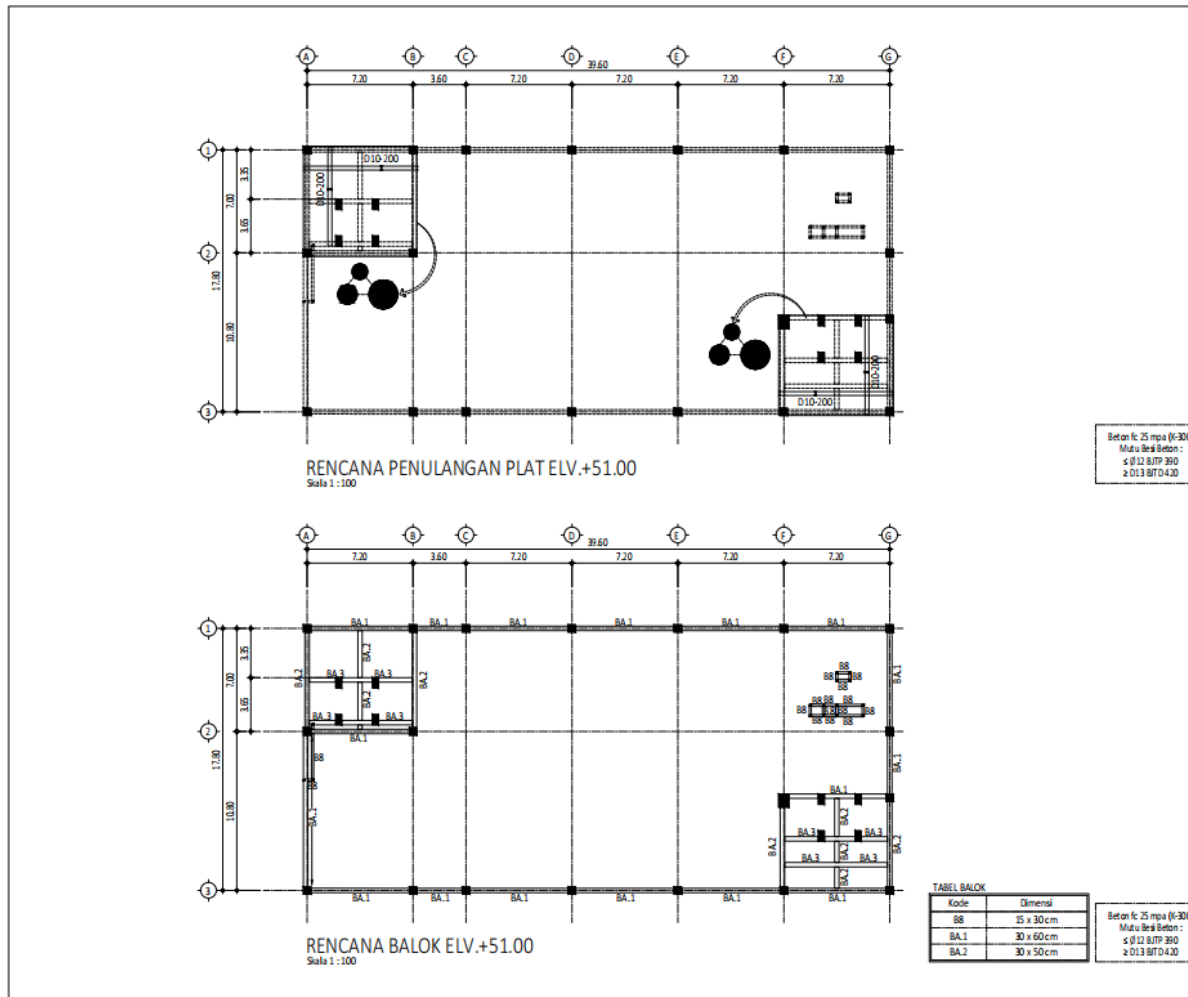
Denah Plat dan Balok Lantai 11
